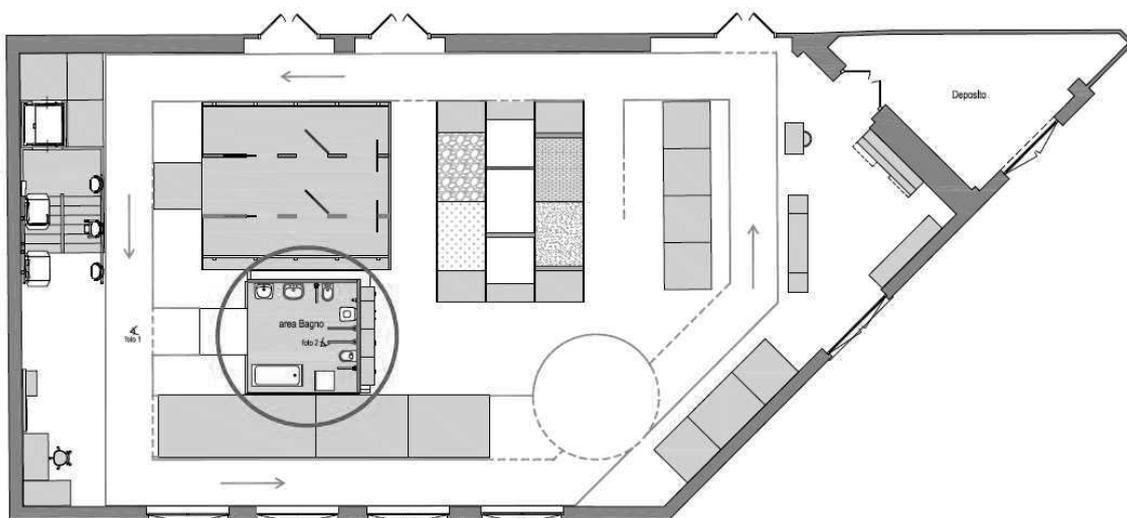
Planimetria Palestra di AUSILIA - Area Bagno
